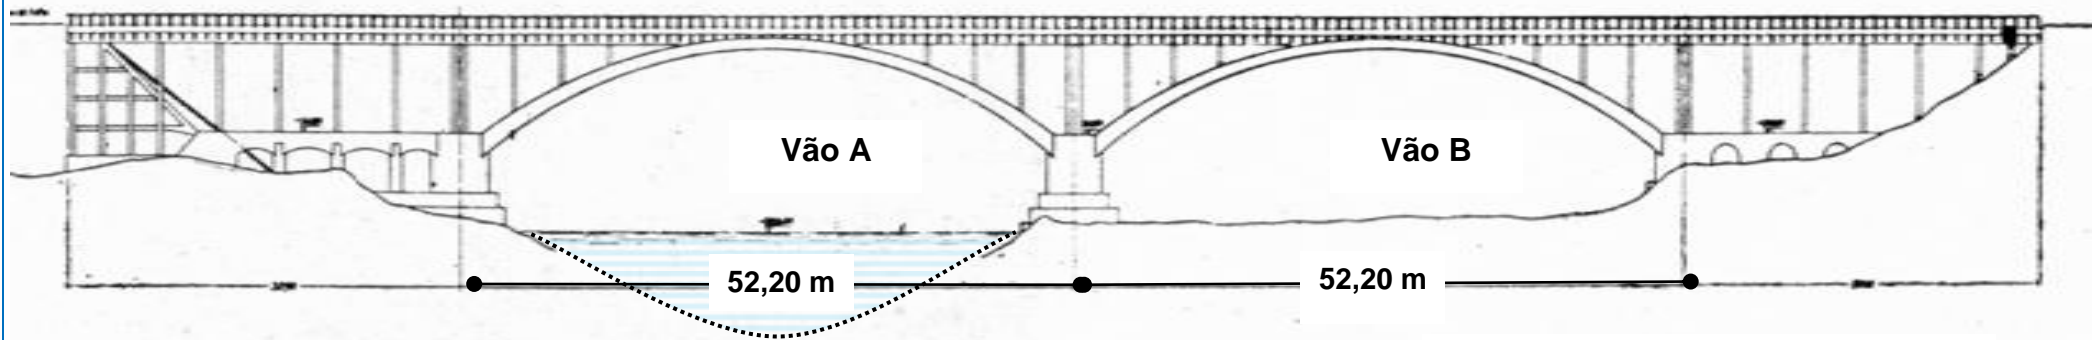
Elevação da ponte ferroviária sobre o Rio Paranaíba
